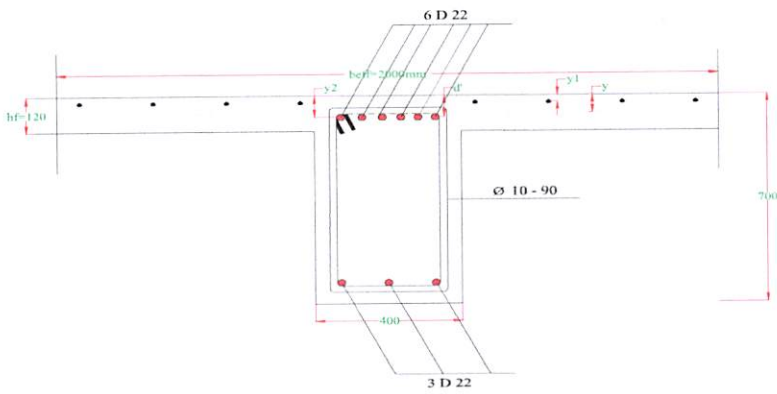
Desain Tulangan longitudinal dan Transversal balok B39
